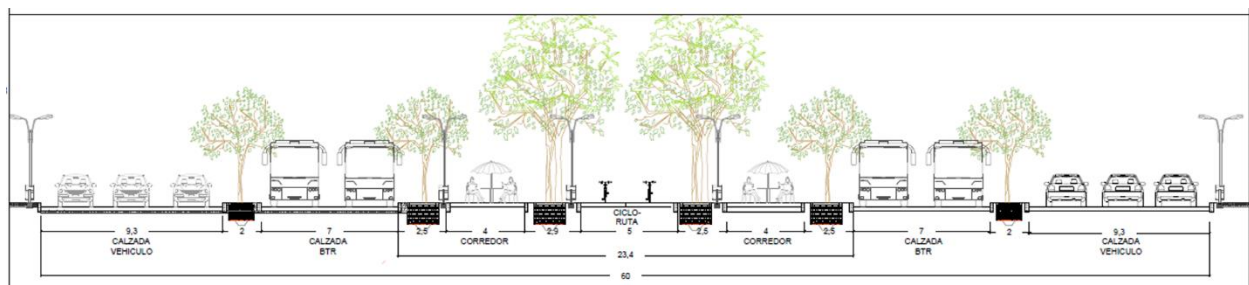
Perfil vial propuesto para la Avenida Centenario.
